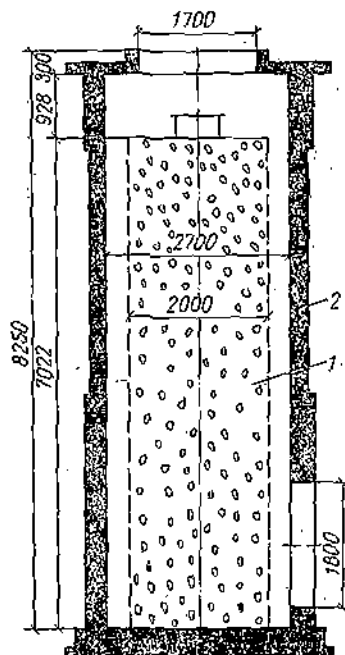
Схема и основные размеры вертикального глушителя с насыпным звукопоглотителем
